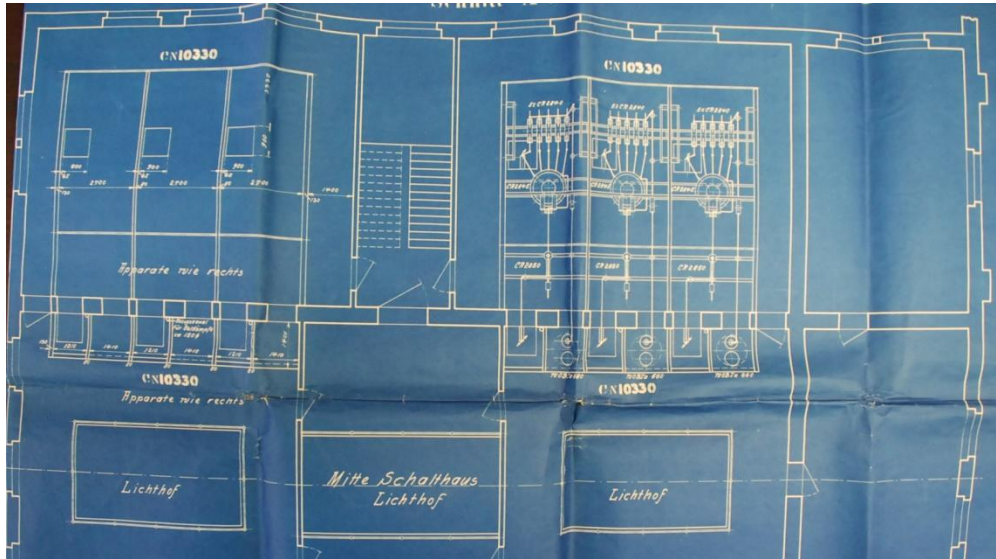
Plano de distribución de Planta Segunda. Edificio de transformadores. Central del Molinar
